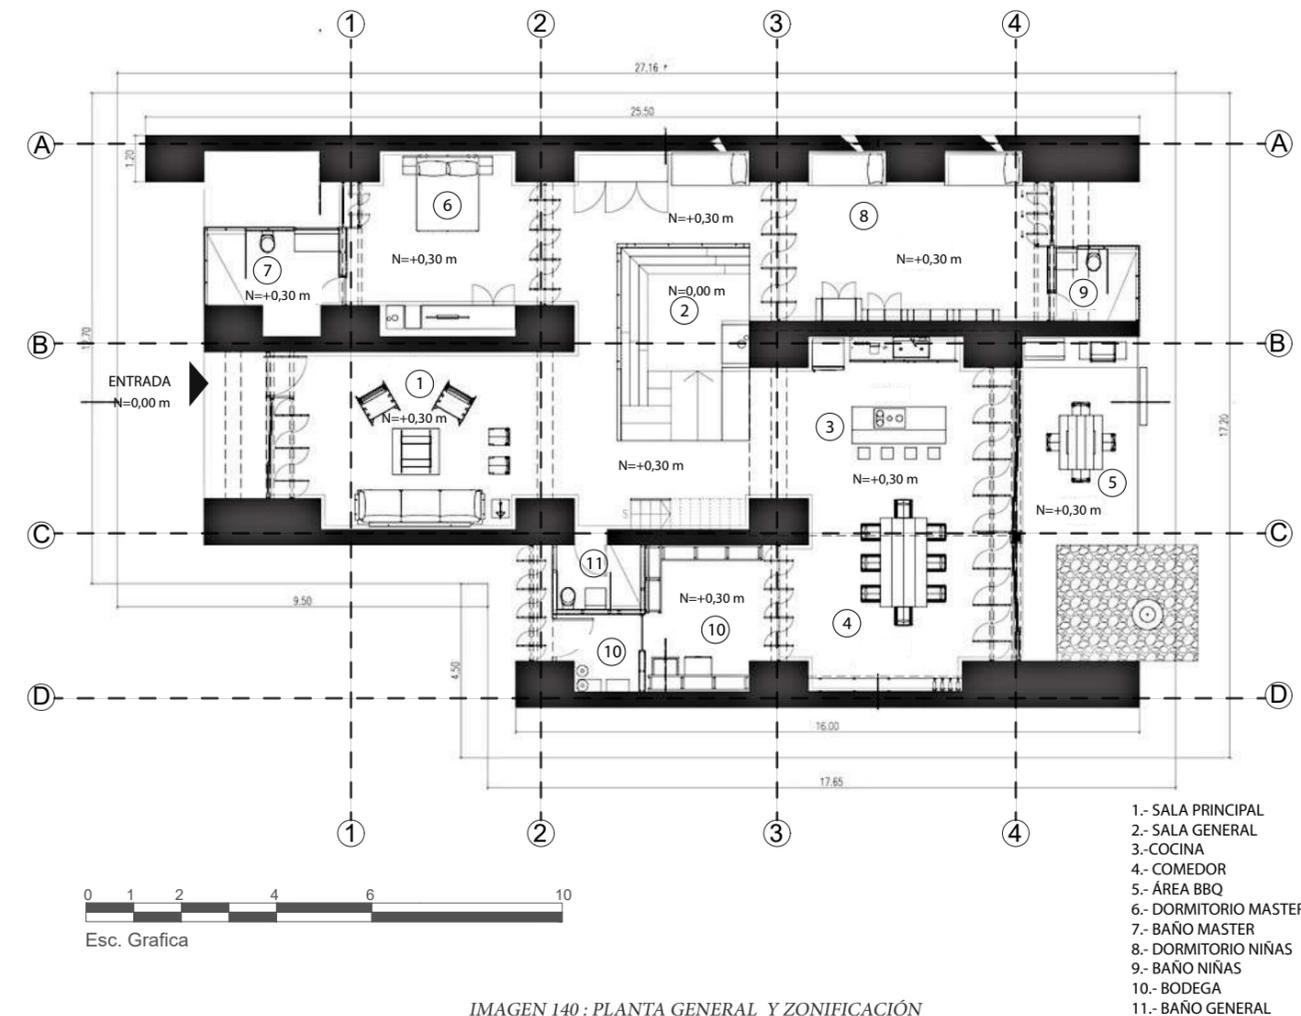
PLANTA GENERAL Y ZONIFICACIÓN
